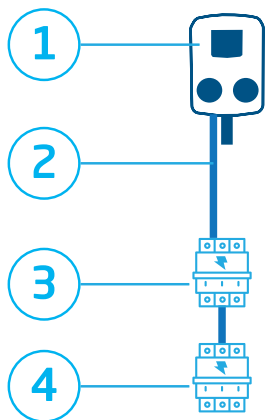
Schema di protezione con cavo di alimentazione singolo
